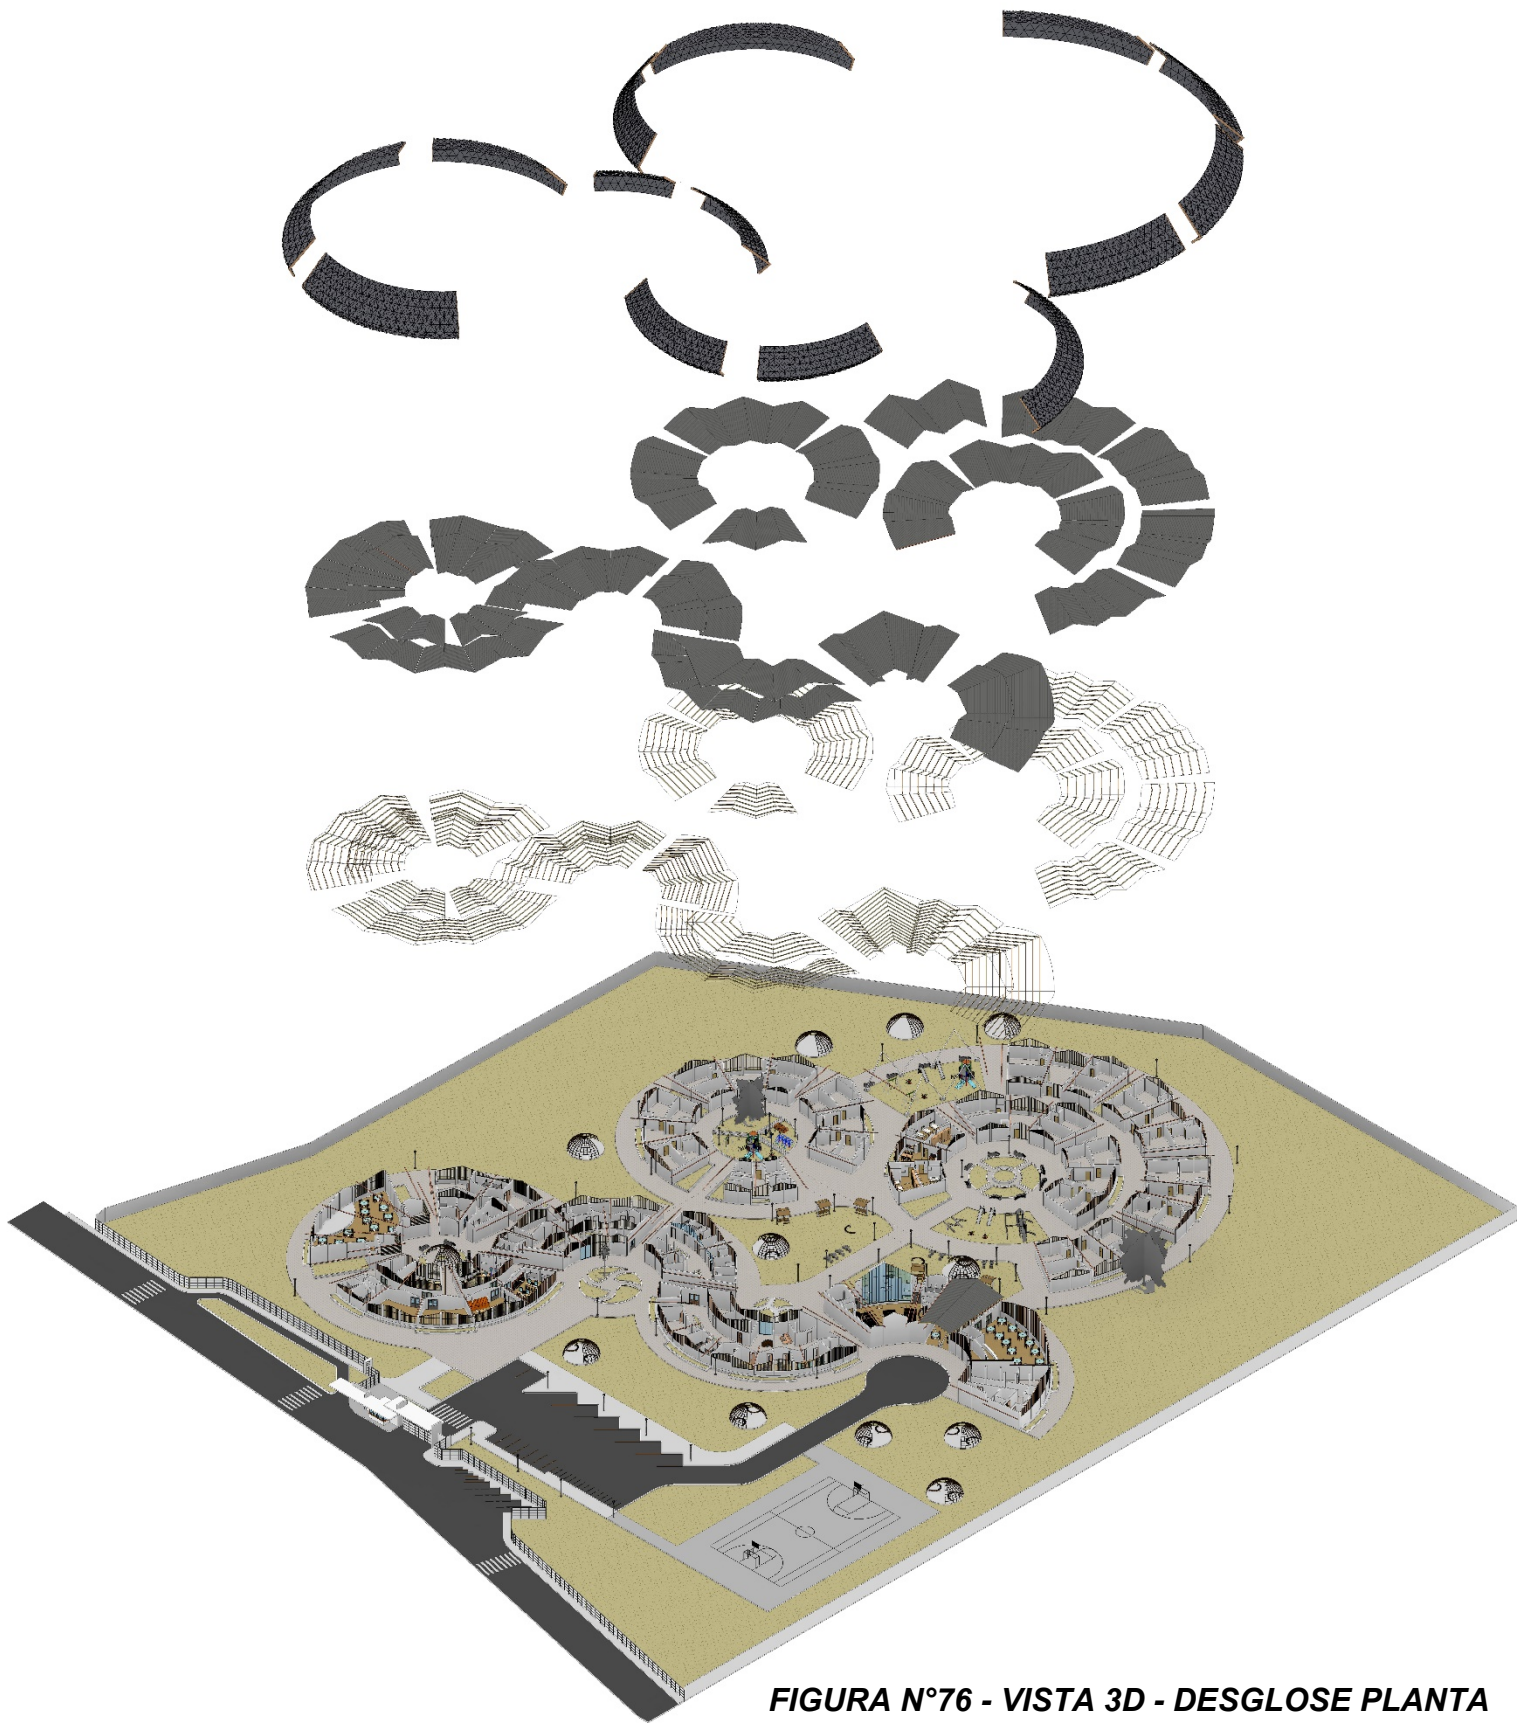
VISTA 3D - DESGLOSE PLANTA
